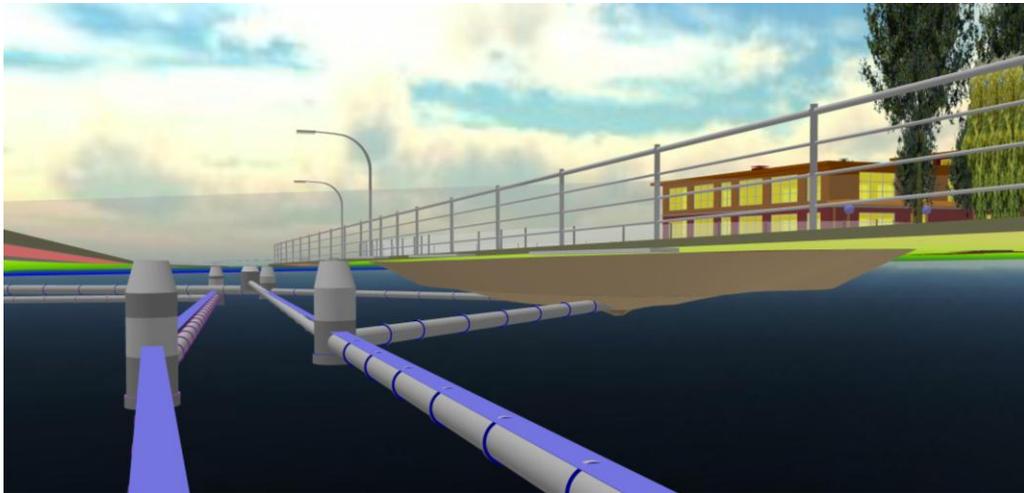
3D Visualisierung des Regenrückhaltebeckens (unterirdisch)
